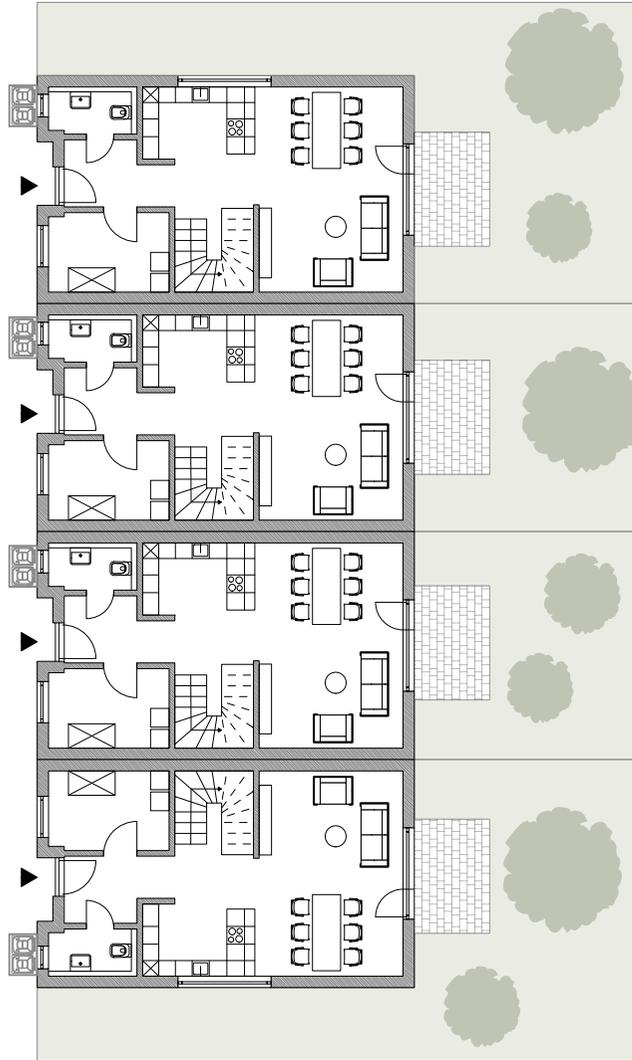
Grundriss Erdgeschoss 1:200
